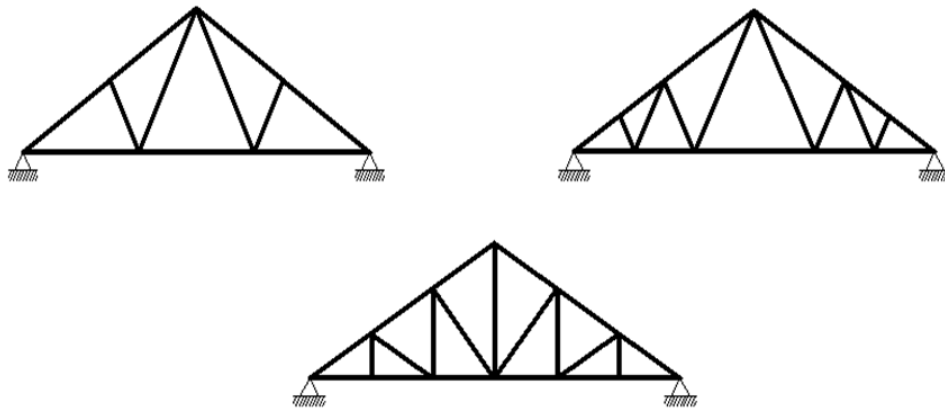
Armaduras típicas empleadas o adecuadas para su empleo en invernaderos.
